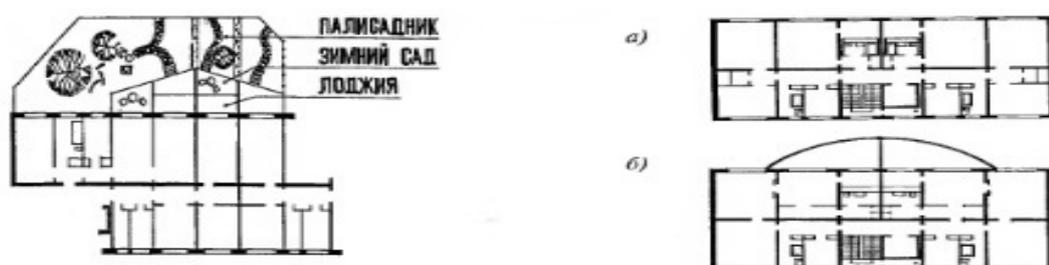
Варианты планировок реконструируемых зданий в районе г. Берлин
